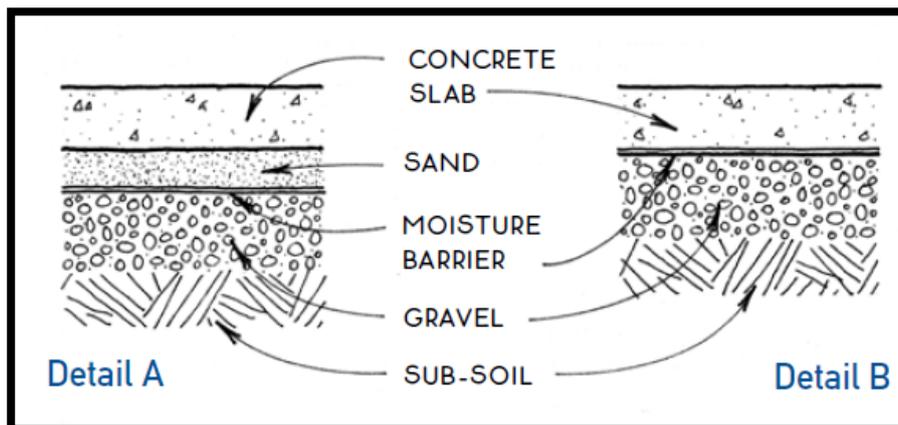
Piso Concreto Primer Piso. Fuente: Frame Construction.
